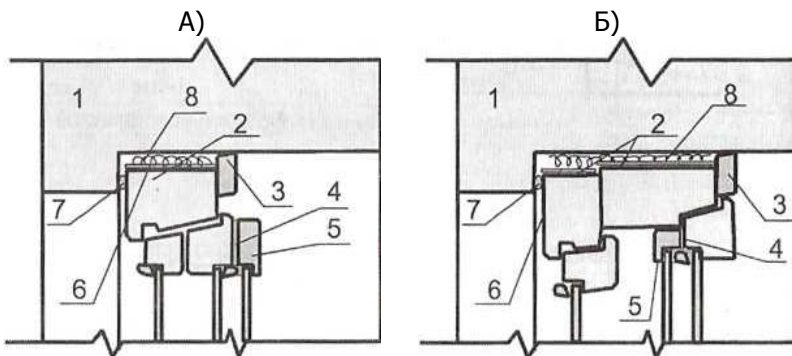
Устройство дополнительных съемных переплетов в оконном блоке со спаренными переплетами (а) и отдельными (б): 1 – стена; 2 – оконная коробка; 3 – внутренний наличник; 4 – герметизирующая прокладка; 5 – дополнительный переплет; 6 – рубероид; 7 – герметик; 8 – конопатка
